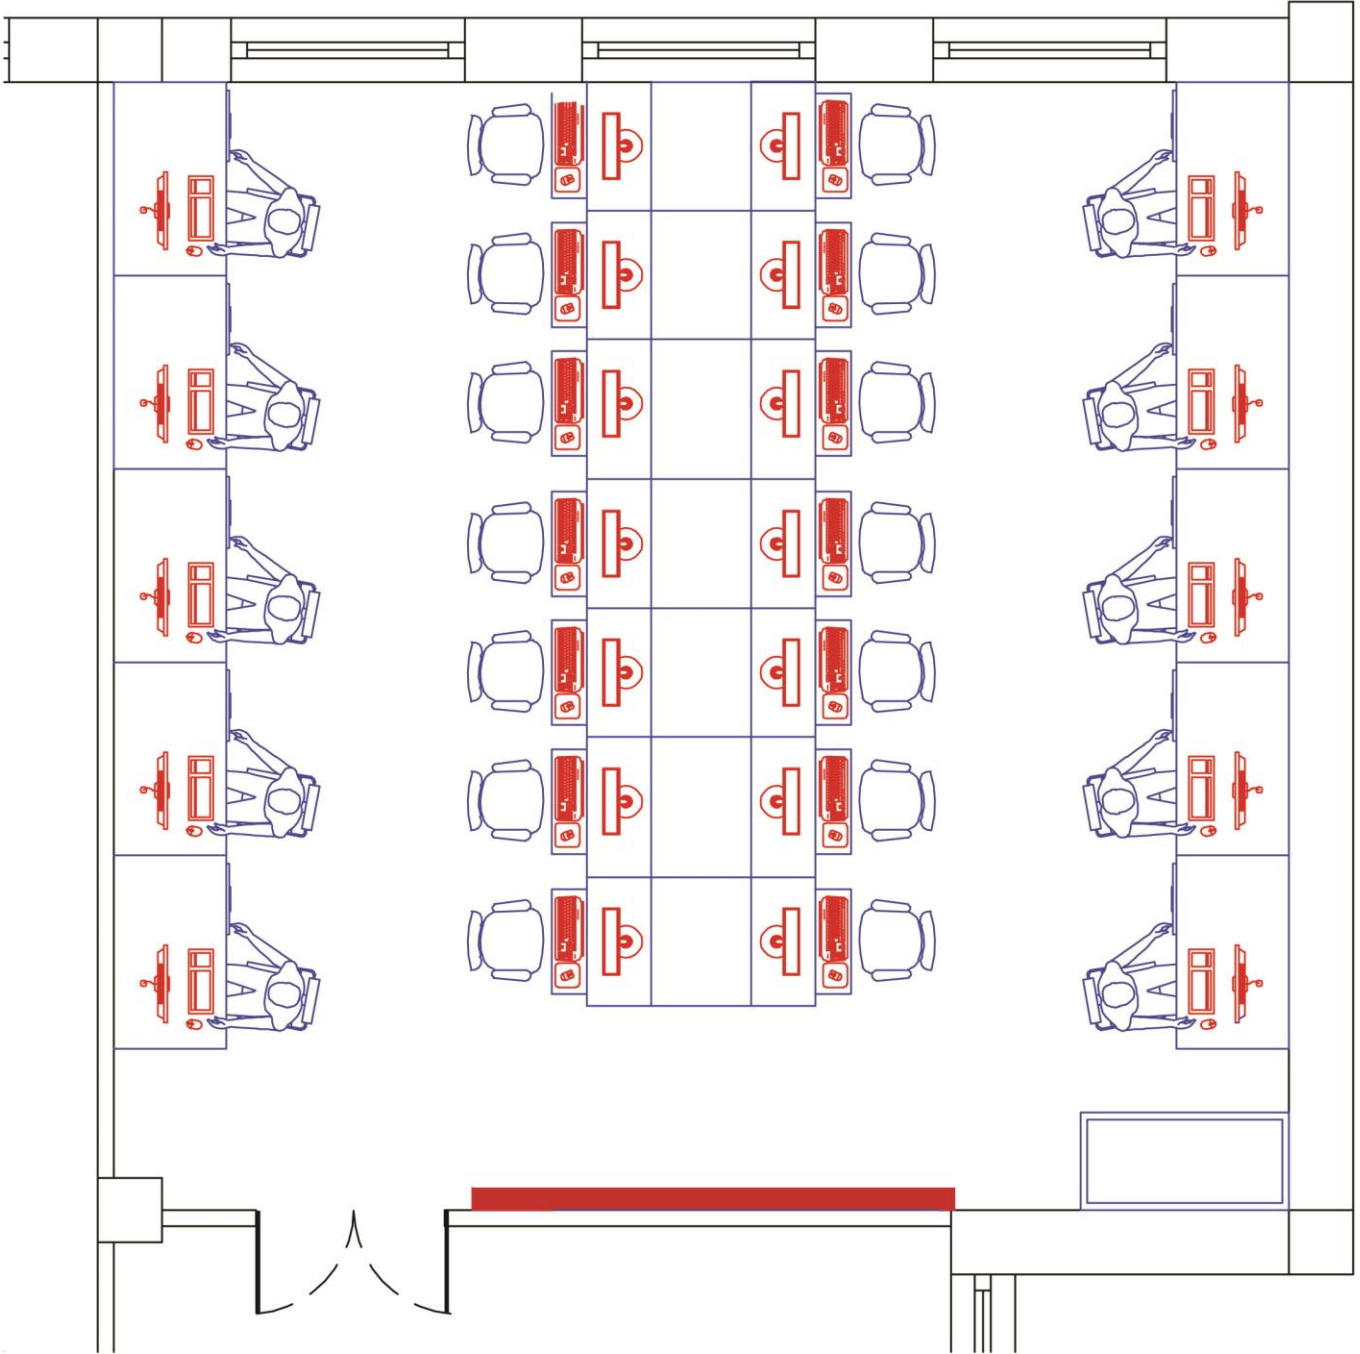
Pianta aule innovative piano primo_ plesso di via Pigno
